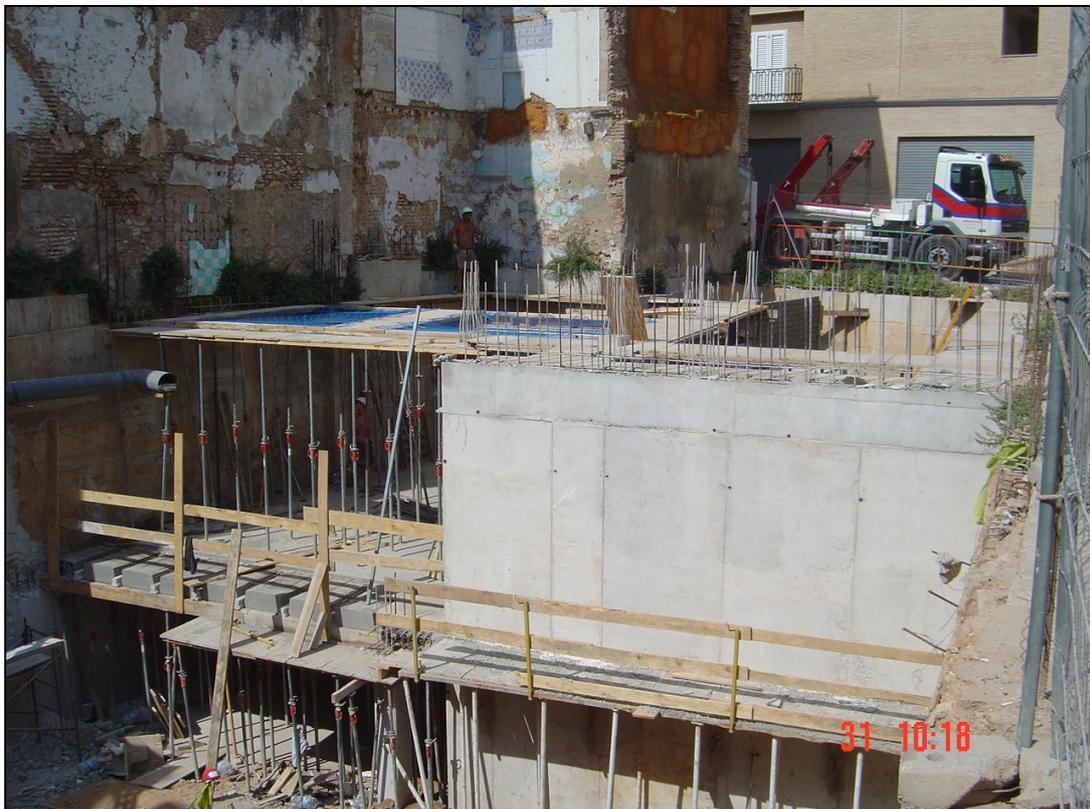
Imagen del forjado encofrándose para su posterior hormigonado.
